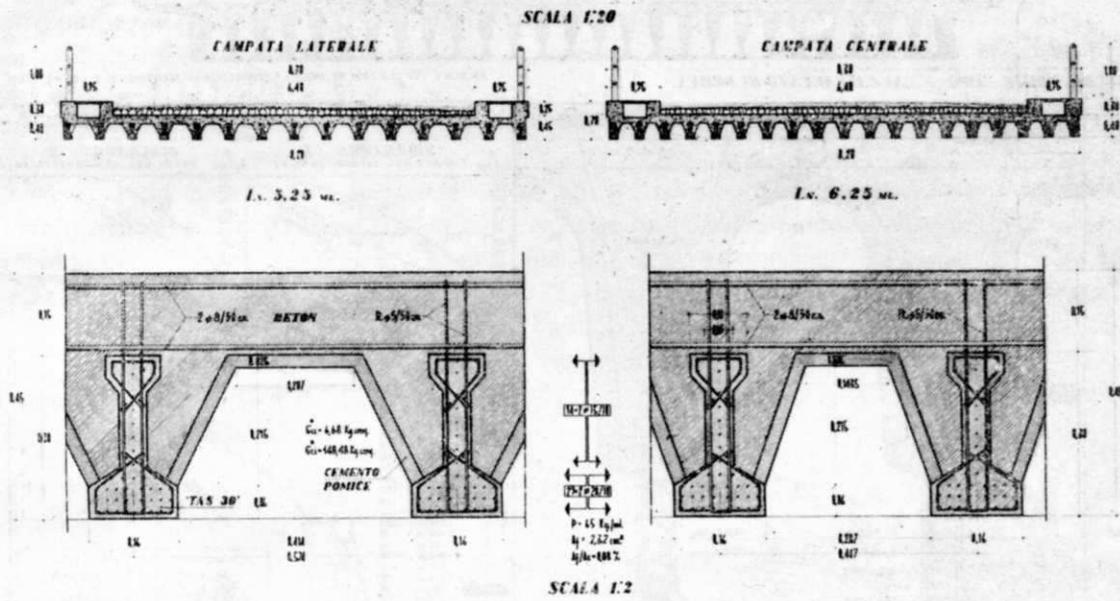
Sezioni e dettagli del ponte dell'ospedale con T.A.S. profilo 30.
